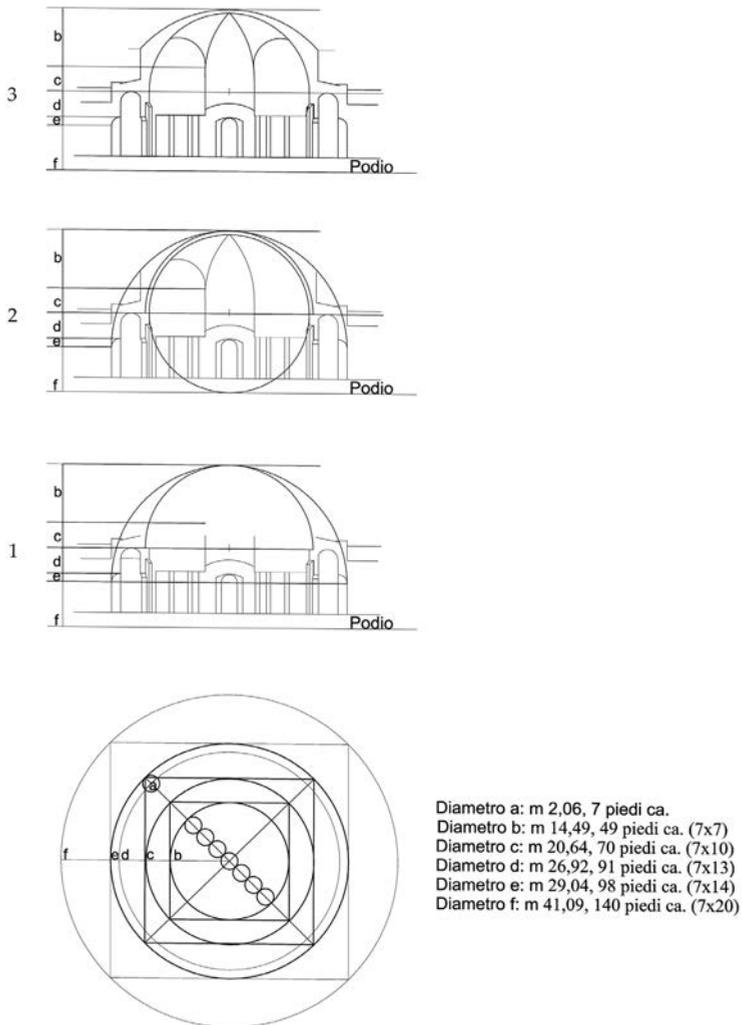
Villa Adriana, Accademia, Atrio Mistilineo, alzato, schema metrico e geometrico alla base del progetto (autore).
